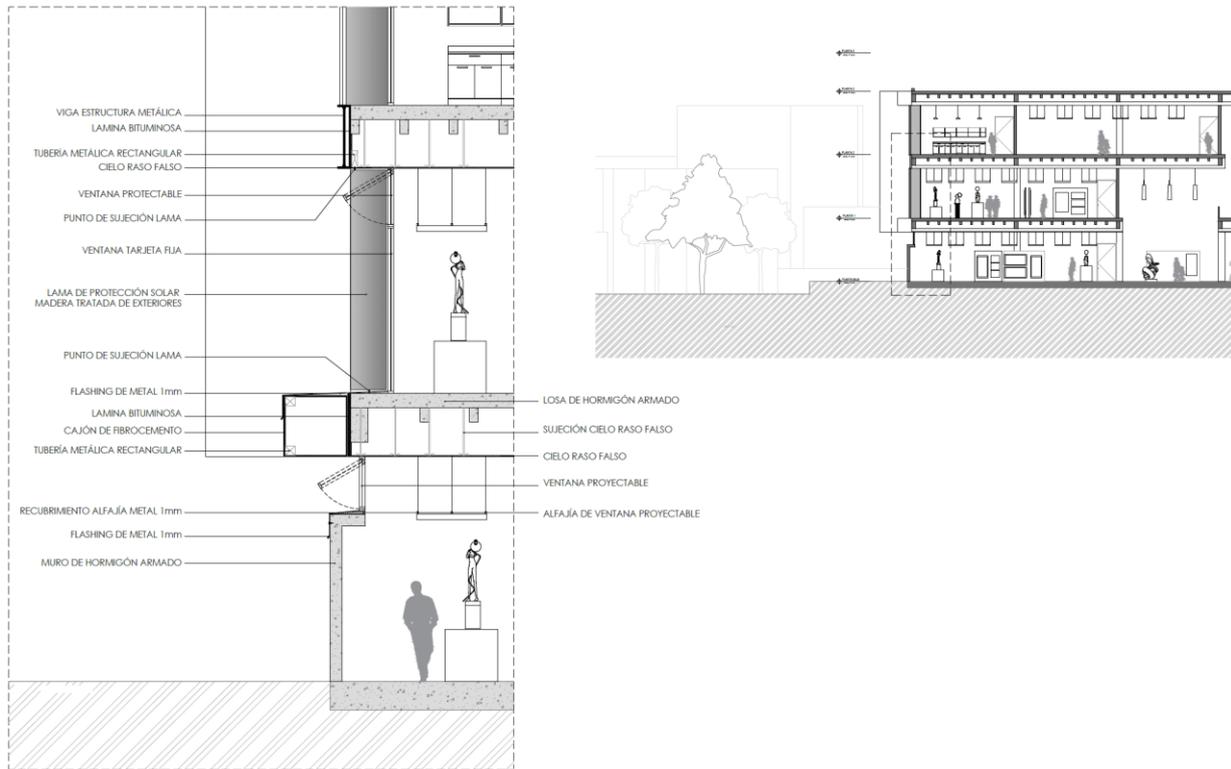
Ampliación - detalle constructivo corte longitudinal A - A'. Elaboración propia.
